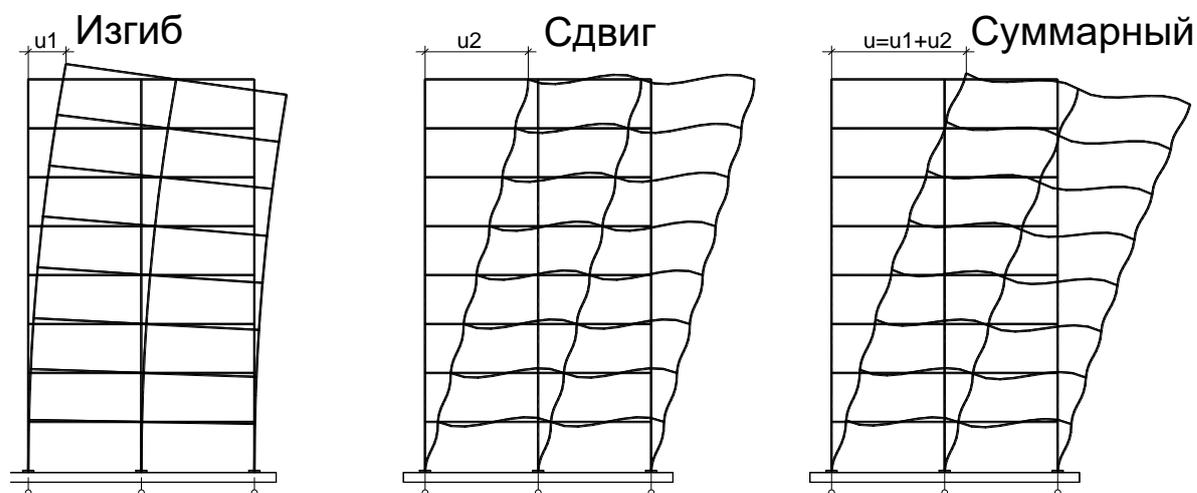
Горизонтальные перемещения каркаса с обычной рамой
